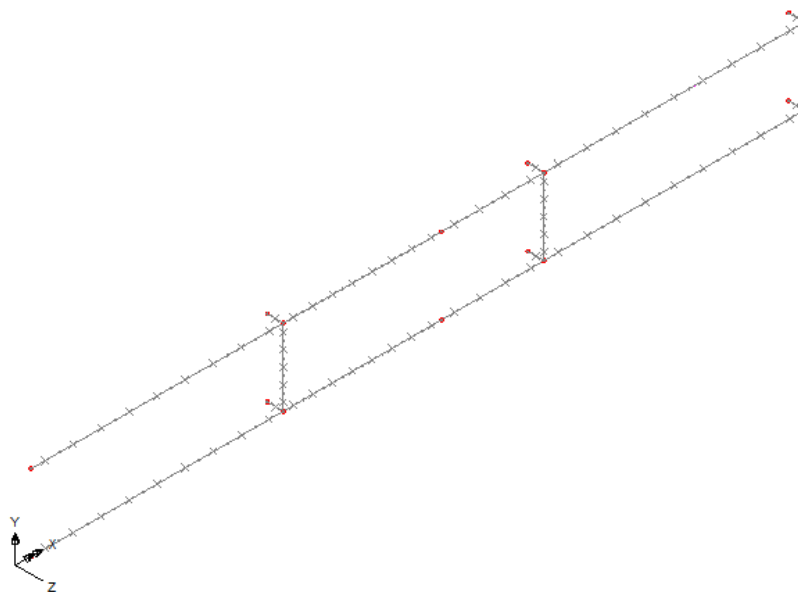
Armadura de reforço da Viga B1, LUSAS
